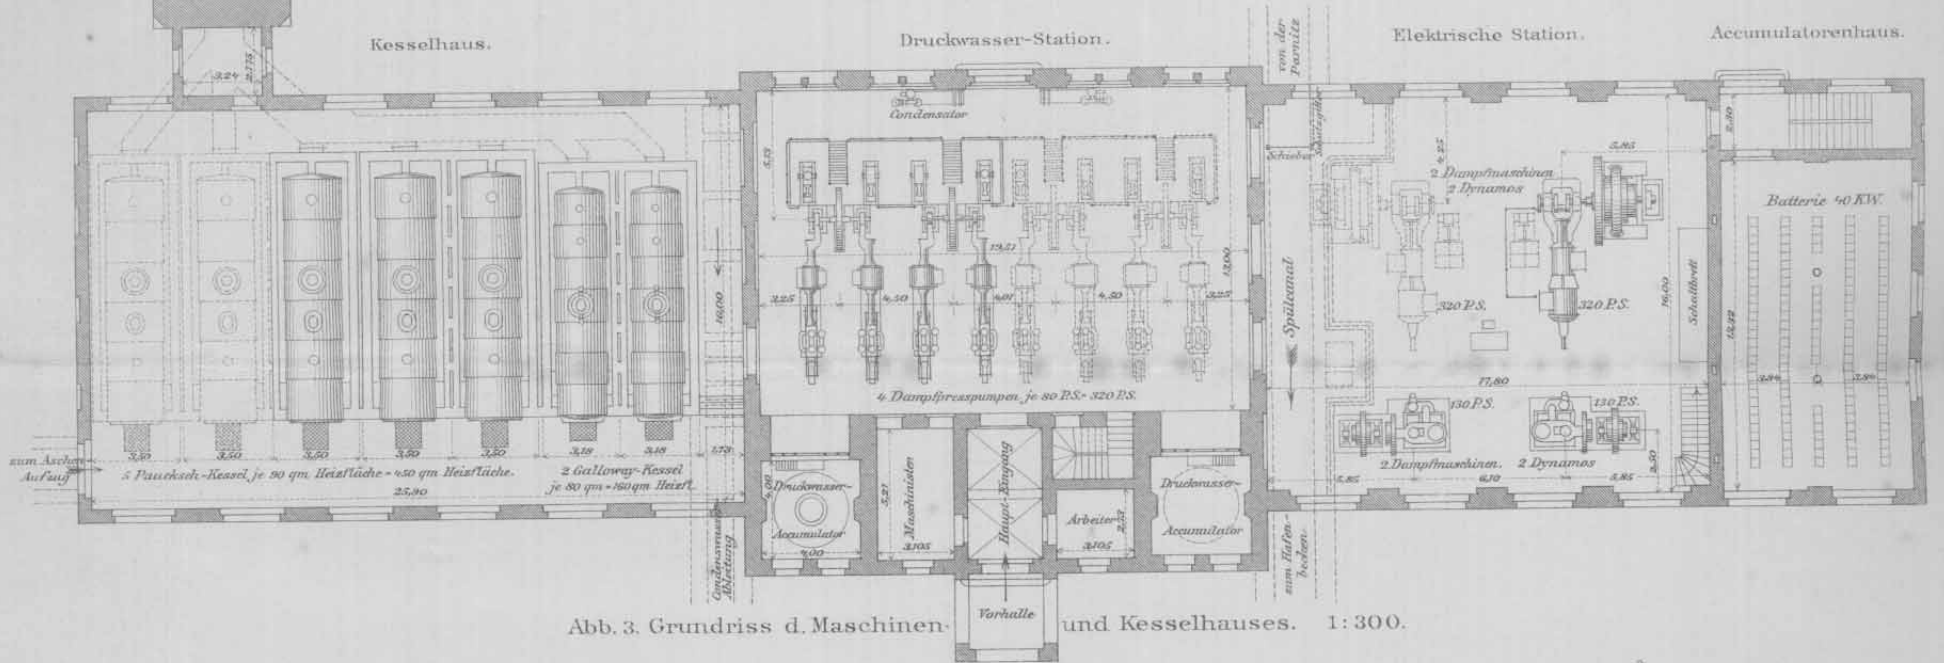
Grundriss d. Maschinen- und Kesselhauses. 1:300.
